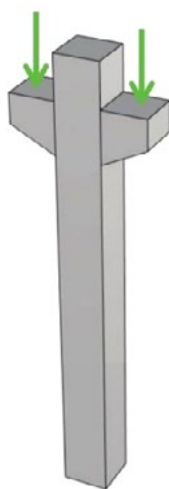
Сосредоточенные нагрузки, моделирующие опирание балки на колонну
